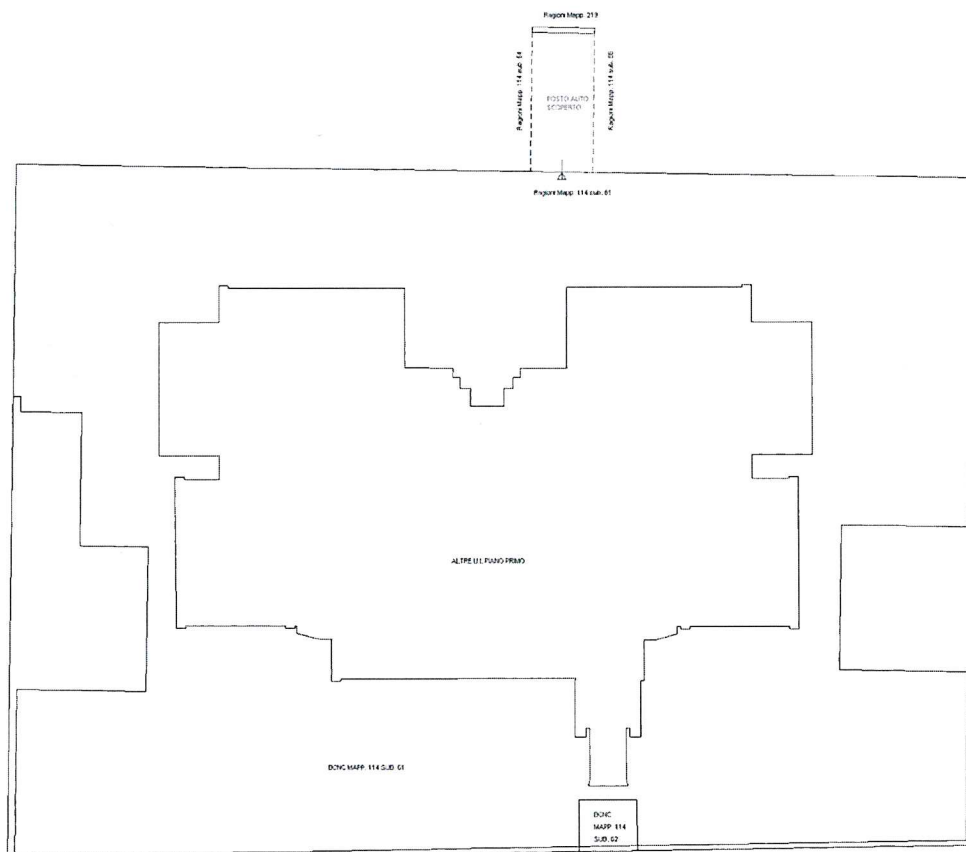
B – Planimetria del Posto Auto (evidenziati in giallo) sito al piano terra in Viale Palmiro Togliatti 114 – Rozzano (MI).
